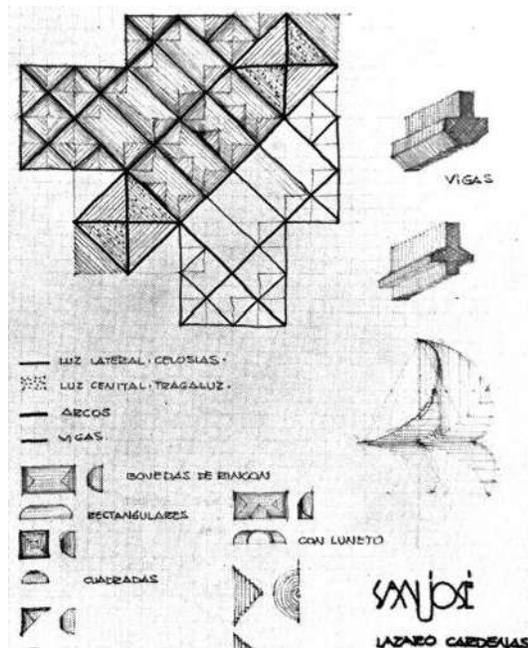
Boceto de la planta del templo de San José, Lázaro Cárdenas, mpio. de Jungapeo.
